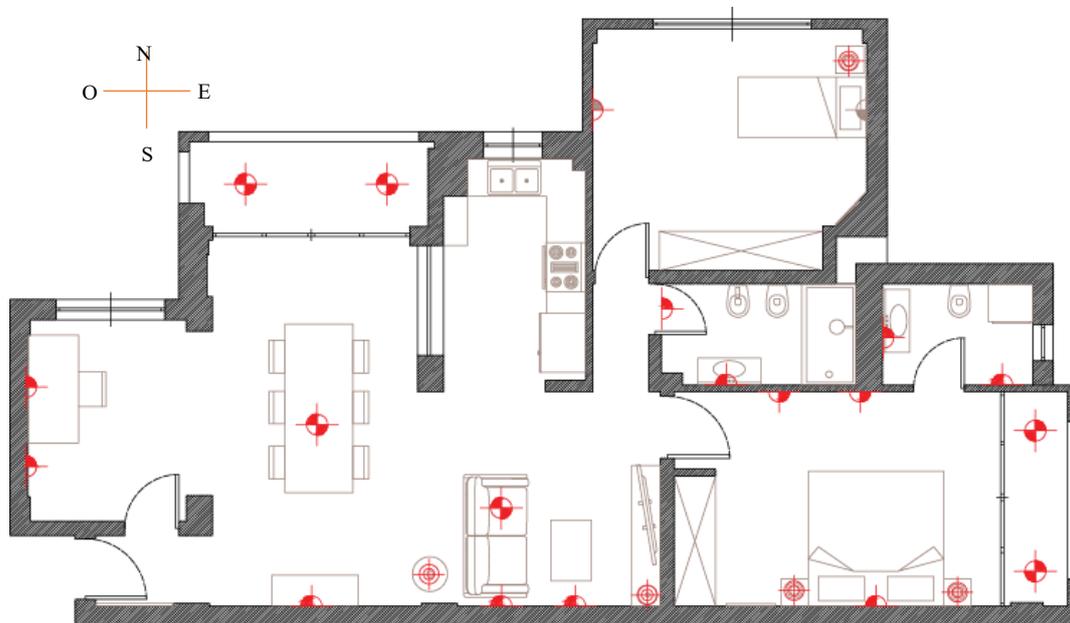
Planimetria dell'appartamento oggetto di studio – stato di progetto (scala 1:200)
